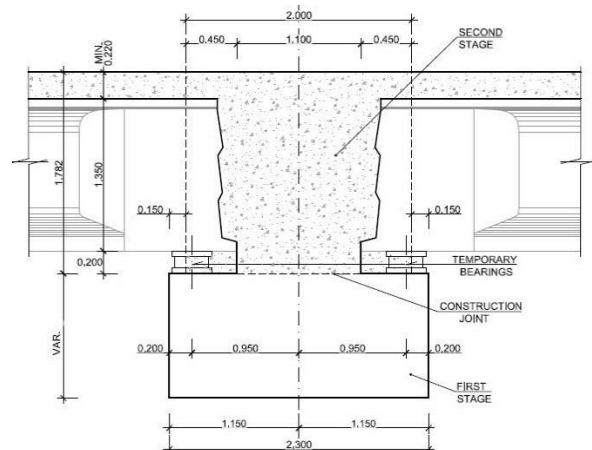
Detalle del empotramiento de vanos con continuidad en puentes bajos
